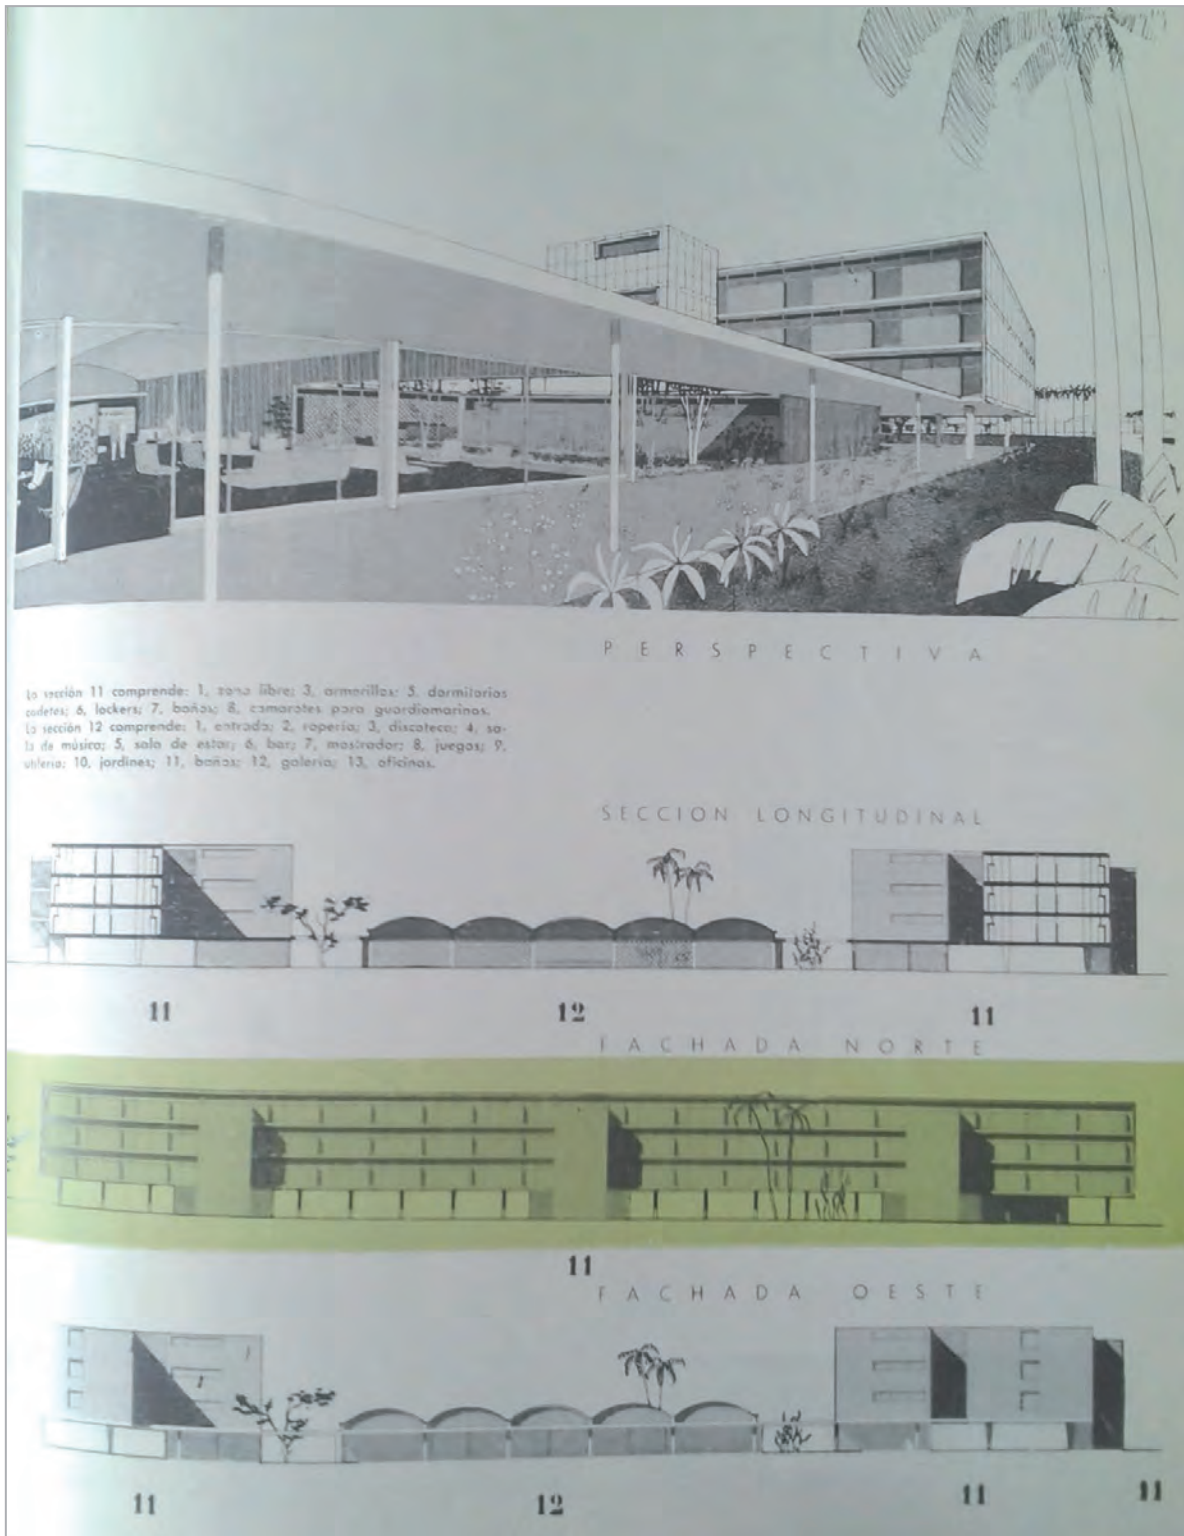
Página de la revista Proa No. 91 de agosto de 1955 que muestra la perspectiva y planos de fachada del edificio de alojamientos y la cámara de cadetes. Se observan las características de su arquitectura y lenguaje moderno: portal, planta libre, modulación de vanos, cubiertas abovedadas, transparencias, etc. Fuente: Revista Proa No. 91, agosto de 1955. Sin paginación.
